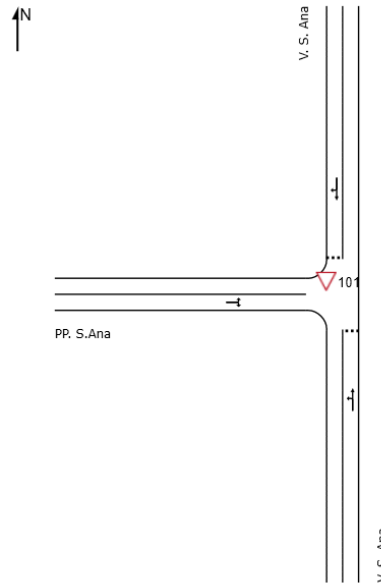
Esquema de la intersección del plan parcial Santa Ana
